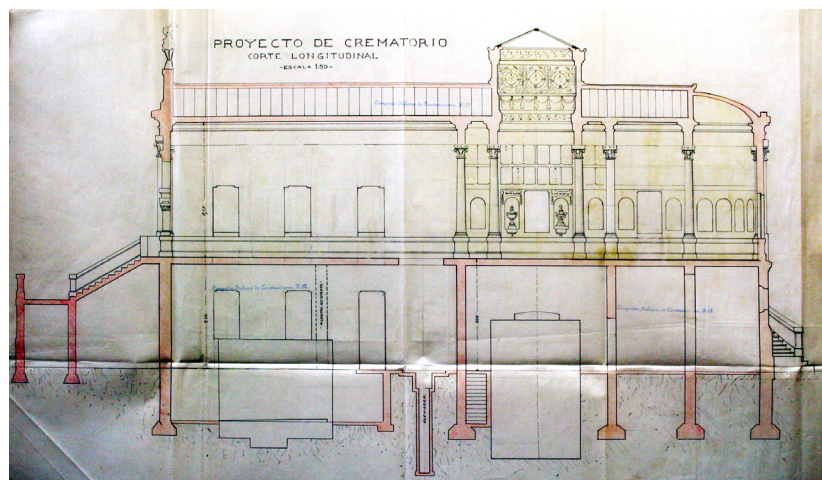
Proyecto de crematorio. Corte longitudinal (Fuente: AHCM, Planoteca, Planos y Proyectos, caja 69, exp. 25, año 1915).
